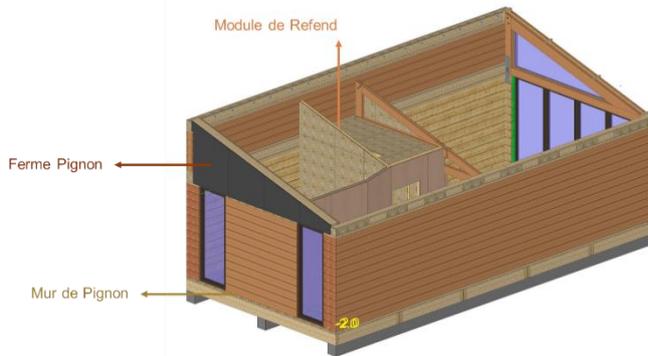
Vue 3D du prototype et module de refend (©ESB)
